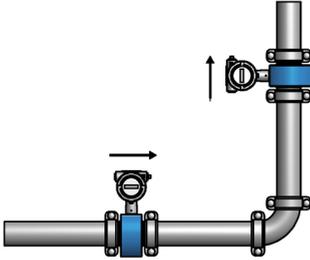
Einbau in horizontale und vertikale Rohrleitungen
